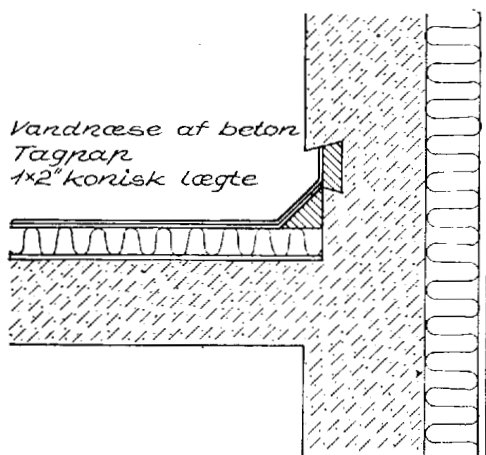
Inddækning med støbt rille til tagpap mellem betonmur og betontag med tagpap.
